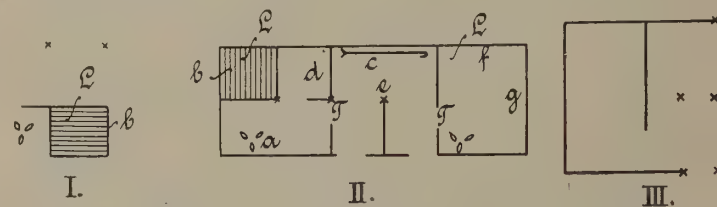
Hütten aus dem Kral am N-Fuß des Hanang, Grundrisse, etwa 1:150.
